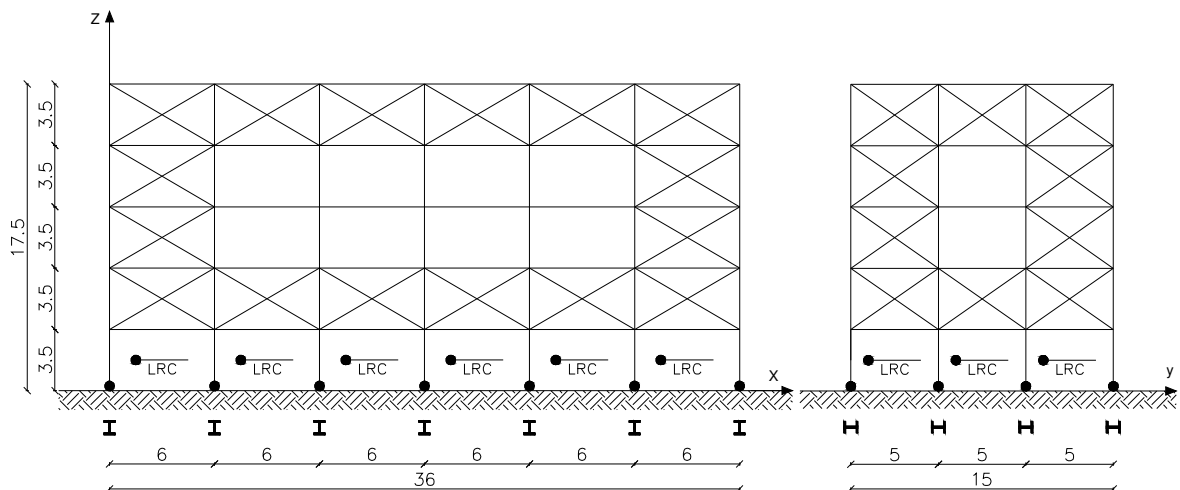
Prospetti dell'edificio in direzione x e y.
